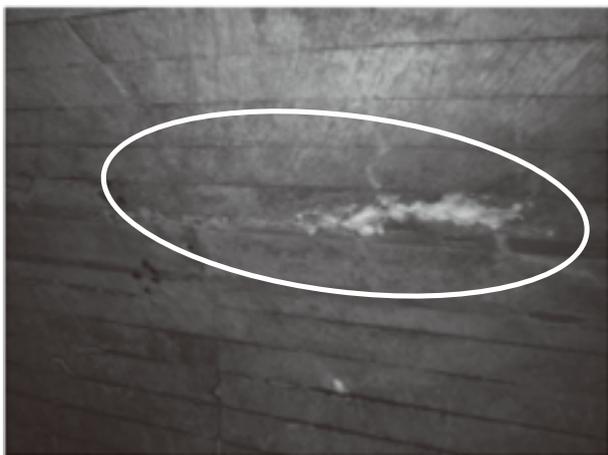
監査廊ひび割れ、エフロレッセンス
